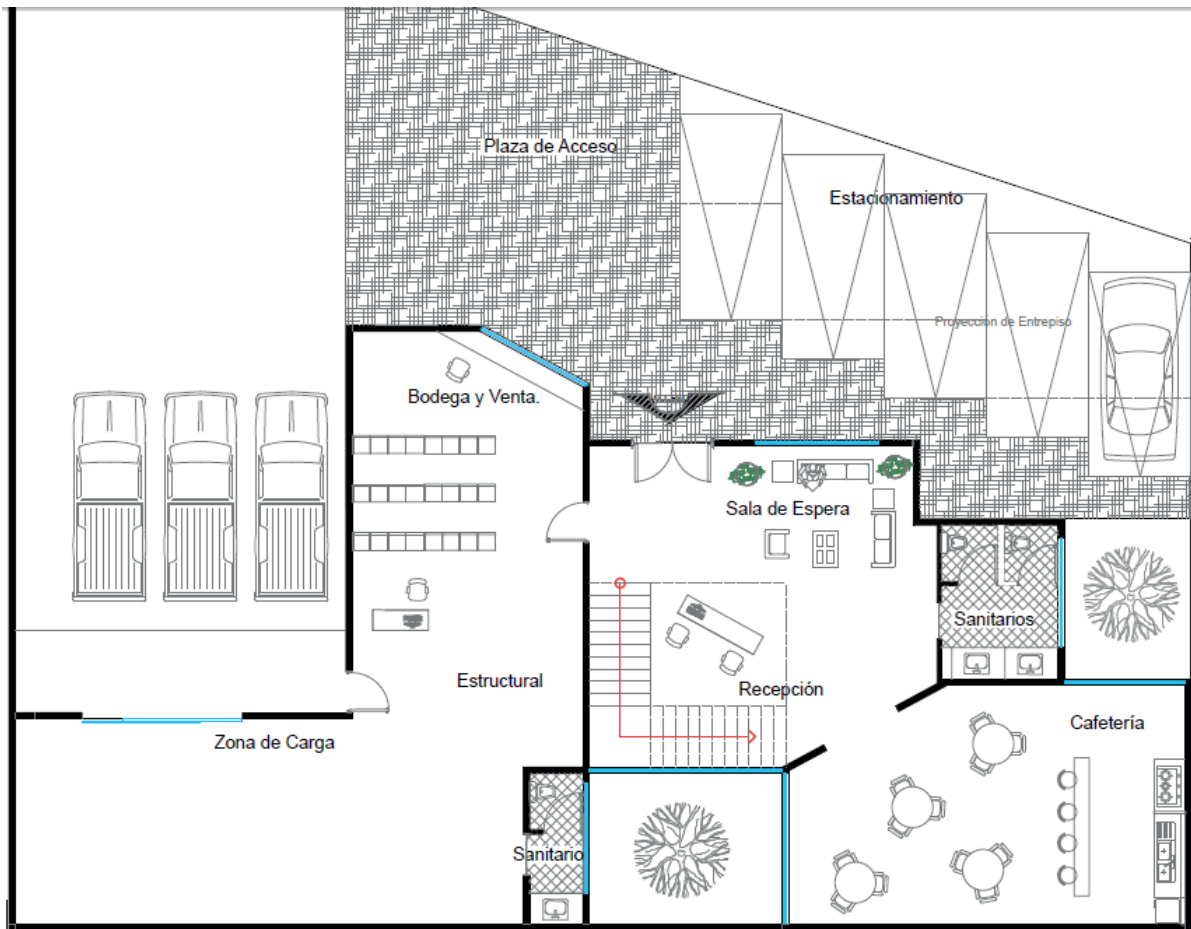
Plano arquitectónico de la planta que se desea construir con detalles de construcción en planta baja.
